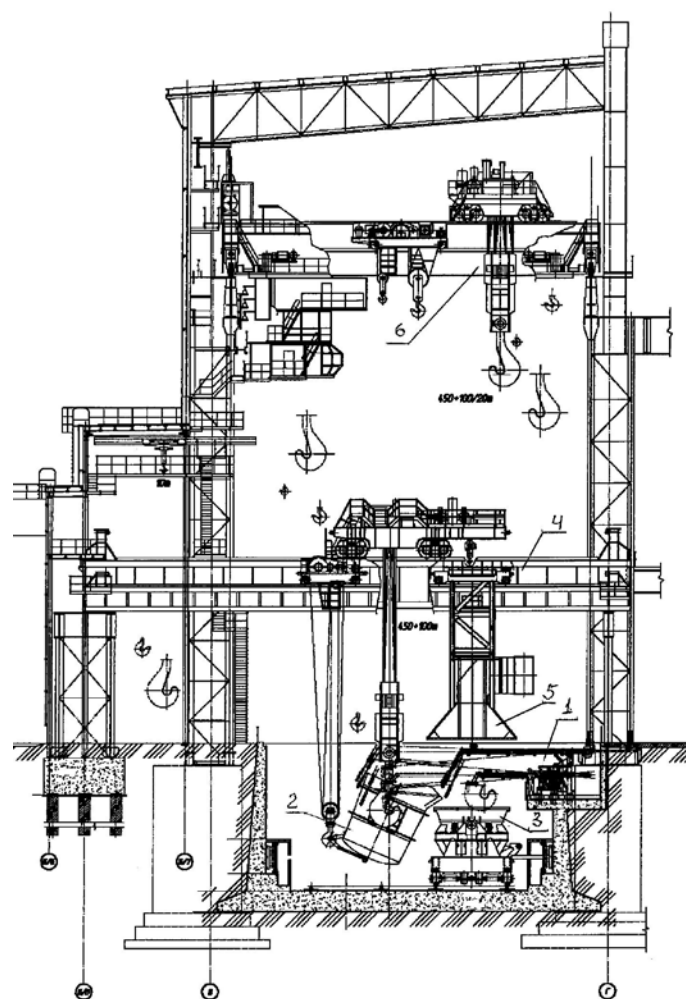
Скачивание шлака из чугуновозного ковша в конвертерном цехе ОАО «Северсталь»: 1 — машина для скачивания шлака; 2 — чугуновозный ковш; 3 — шлаковоз со шлаковым ковшом; 4 — стационарный мост с тележкой; 5 — зонт отвода графитсодержащей пыли; 6 — мостовой заливочный кран
